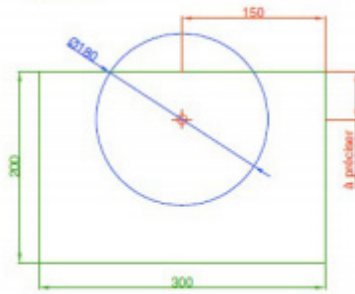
Exemple d'un essai de déboutonnage pour une fixation au centre et en bord
